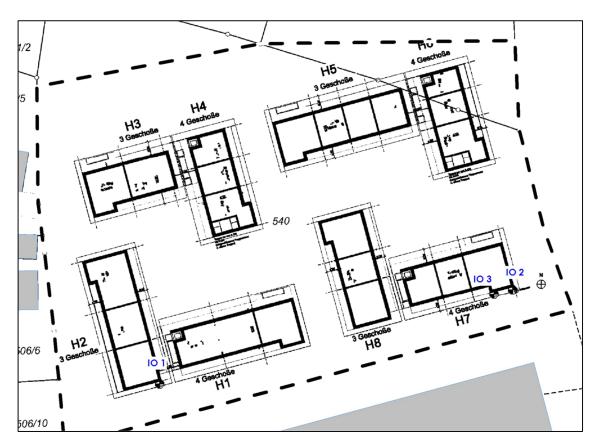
Lageplan mit Darstellung der Immissionsorte (IO)
